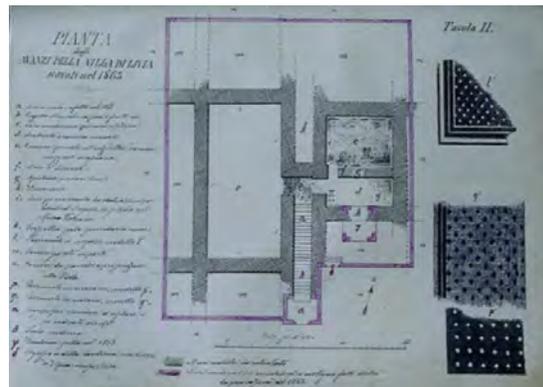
Planta de las salas hipogeas, 1863 (SAR).
